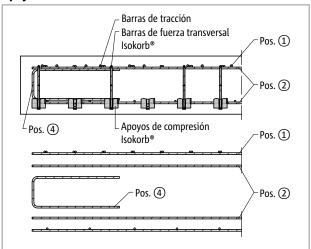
Schöck Isokorb® XT tipo K-M1 hasta M10: Armadura in situ del lado del balcón en la sección A-A; pos. 4 = refuerzo constructivo en el borde libre
